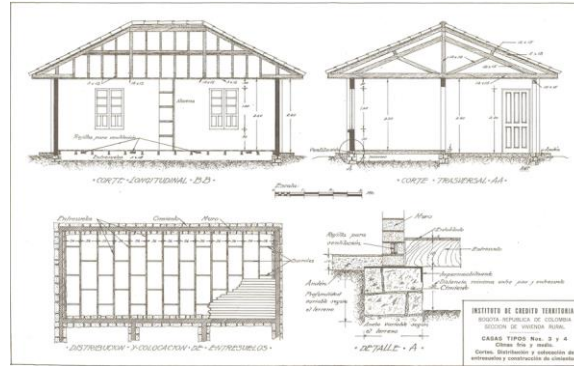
Cortes y detalles constructivos de la vivienda para 4 personas.
